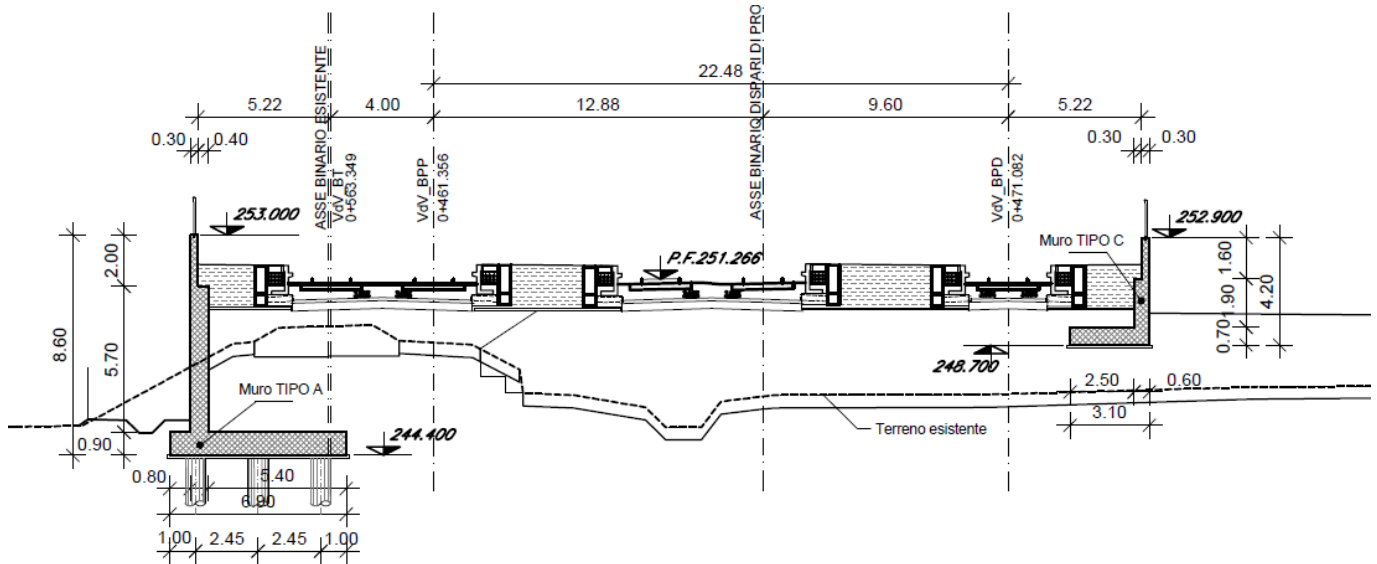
Muro Tipo A e Tipo C – Sezione trasversale tipo
